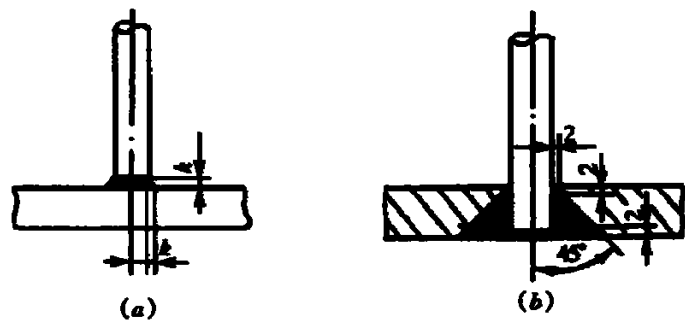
预埋件钢筋电弧焊 T 型接头
